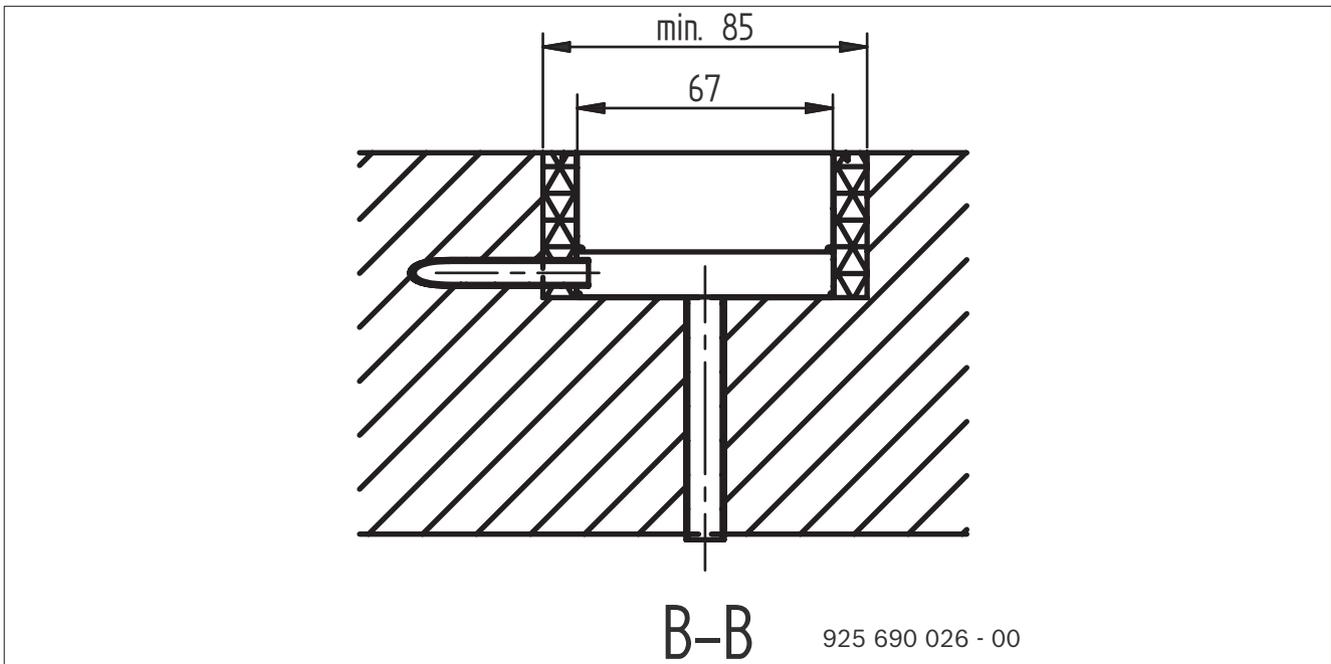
Grubenplan BD 6xx mit Einbauwanne - Schnitt B-B
